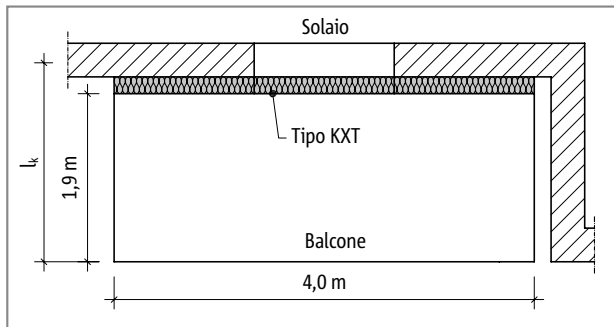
Schöck Isokorb® tipo KXT: pianta
